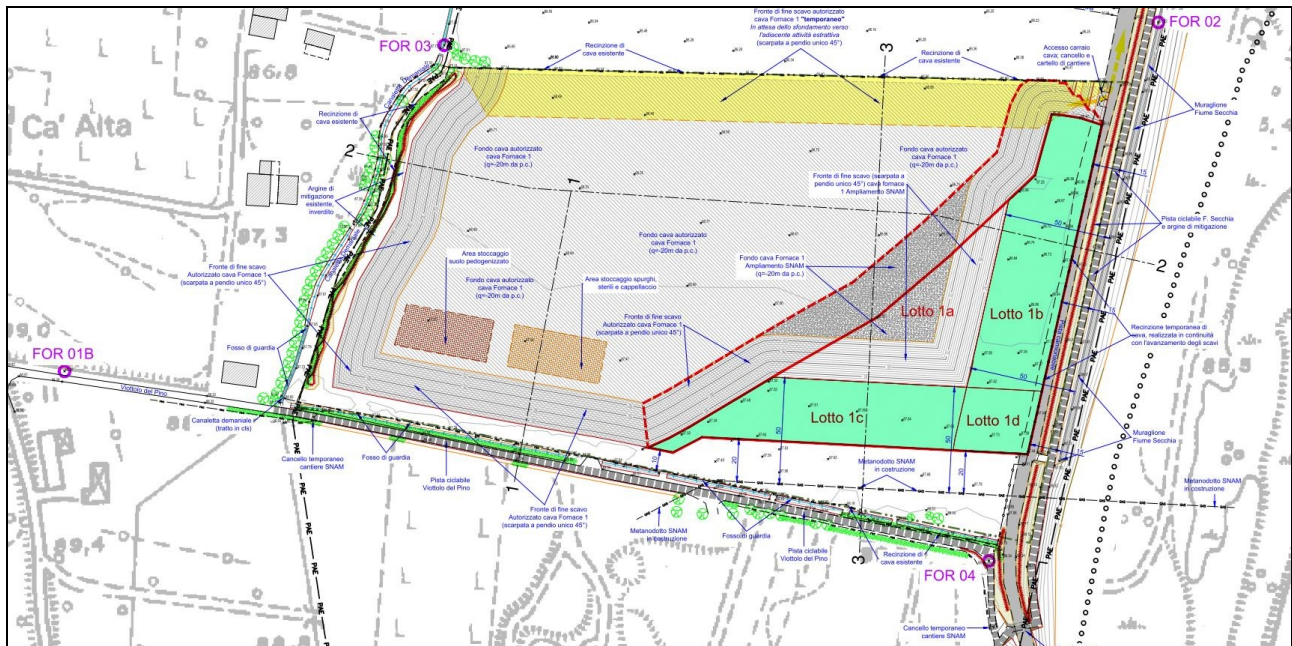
Stralcio Tav. 06 – Progetto "Planimetria di minimo scavo" (scala grafica). In giallo si noti la scarpata temporanea da mantenersi a separazione con aree di cava sul lato nord.
